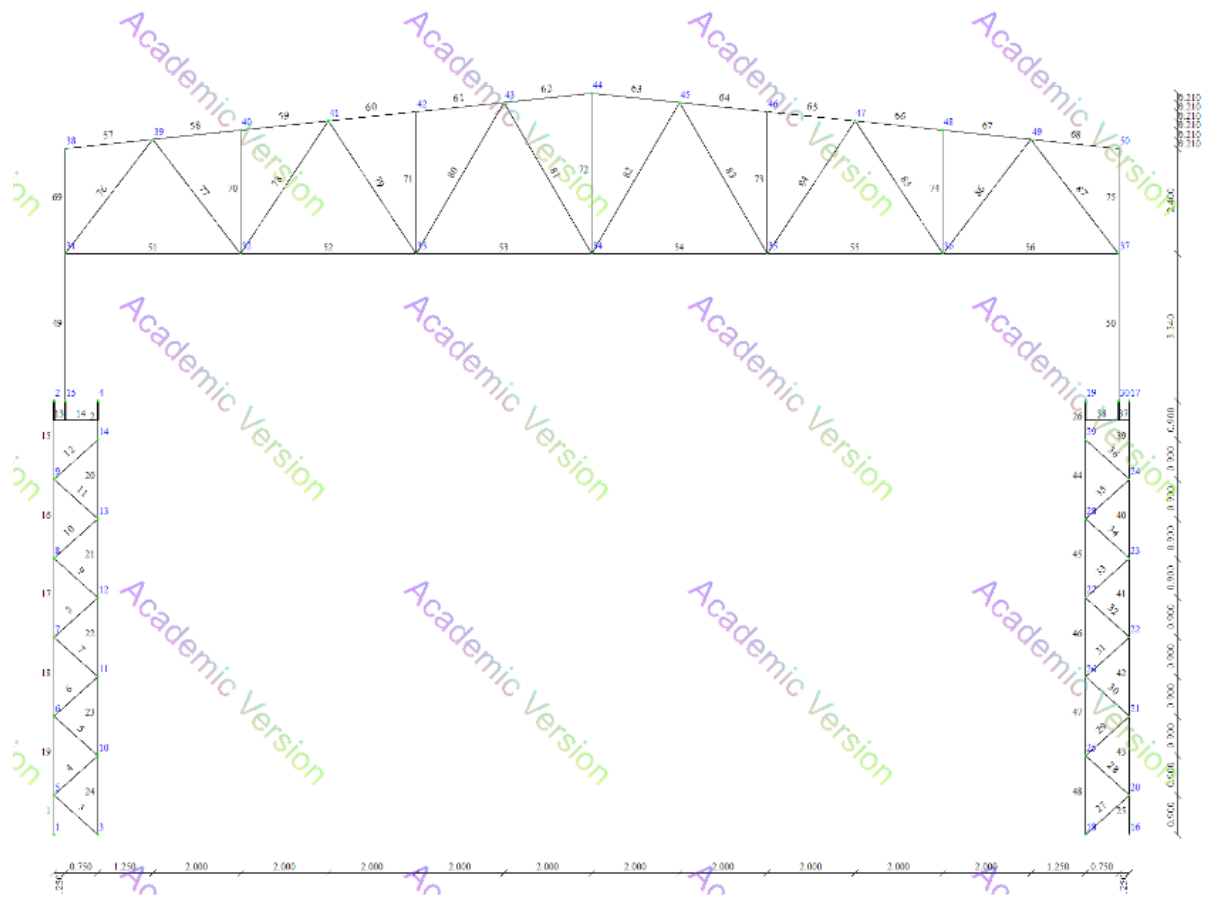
Загальний вигляд рами промислової будівлі з першим варіантом ферми
